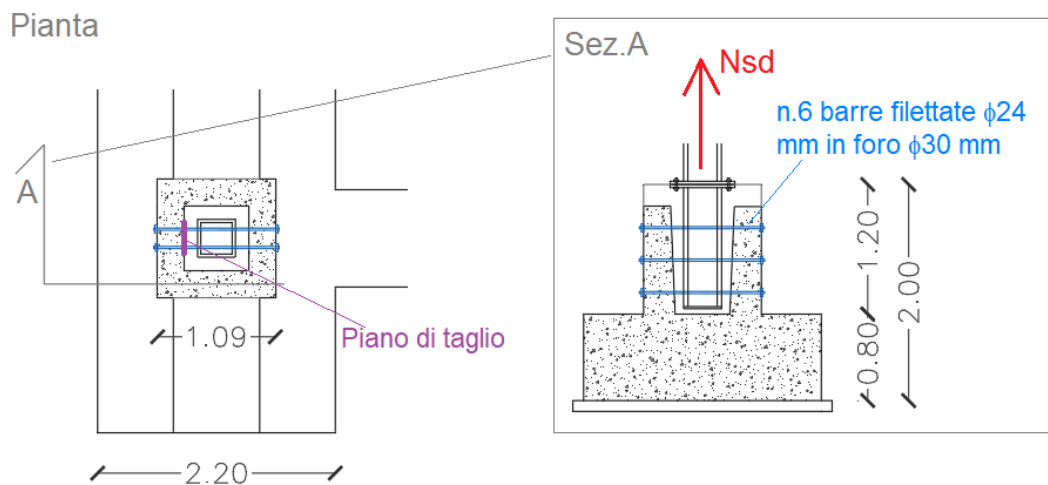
SCHEMA UNIONE TUBOLARE IN ACCIAIO-PLINTO A BICCHIERE, CON INDICAZIONE AZIONE DI PROGETTO E PIANO DI TAGLIO
